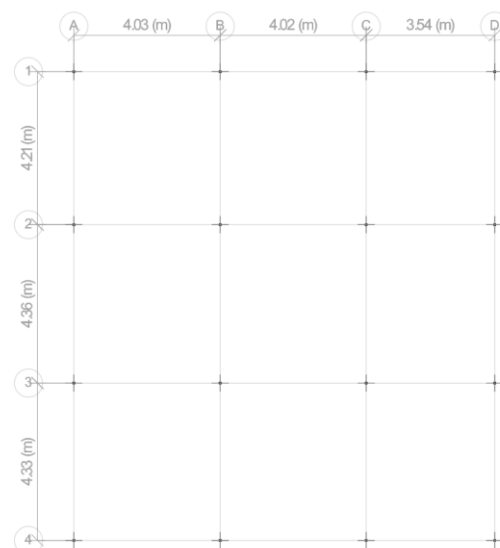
Vista en planta edificaciones de 4 y 8 pisos
